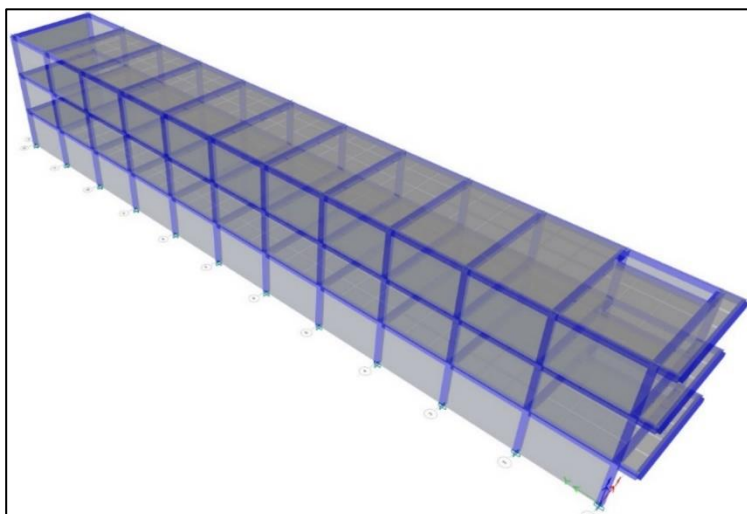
Modelado de la Vivienda N°2, Fuente: Etabs.
